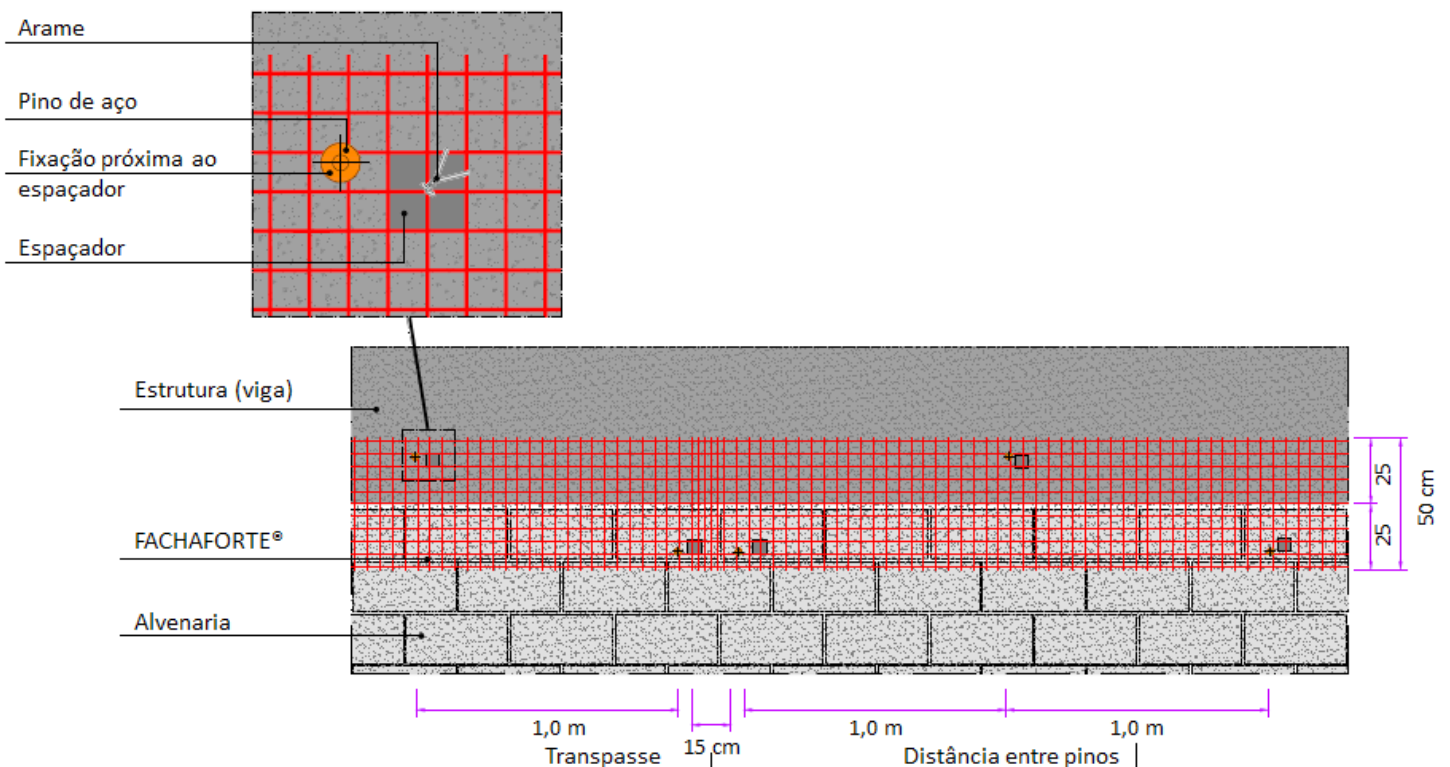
Posicionamento e fixação da FACHAFORTE® (Vista)
